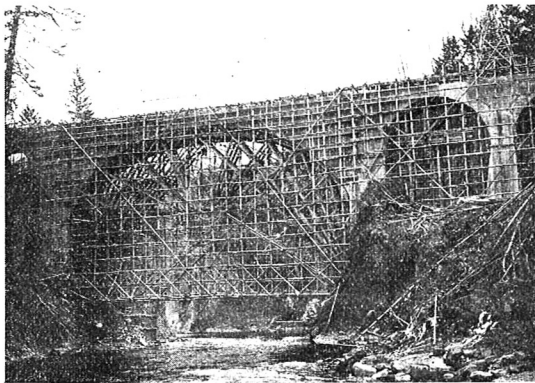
32 m 鉄筋コンクリート拱の拱架竣工
